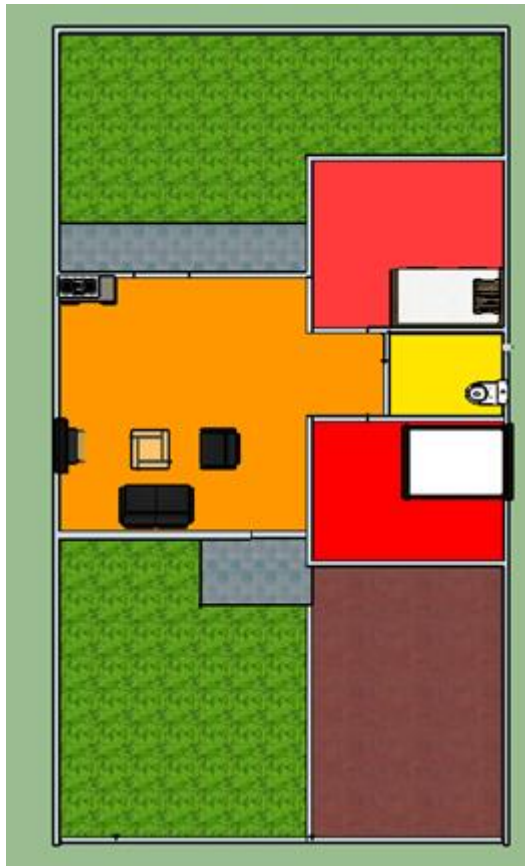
Tipe 38 Tampak Atas Bagian Lantai
